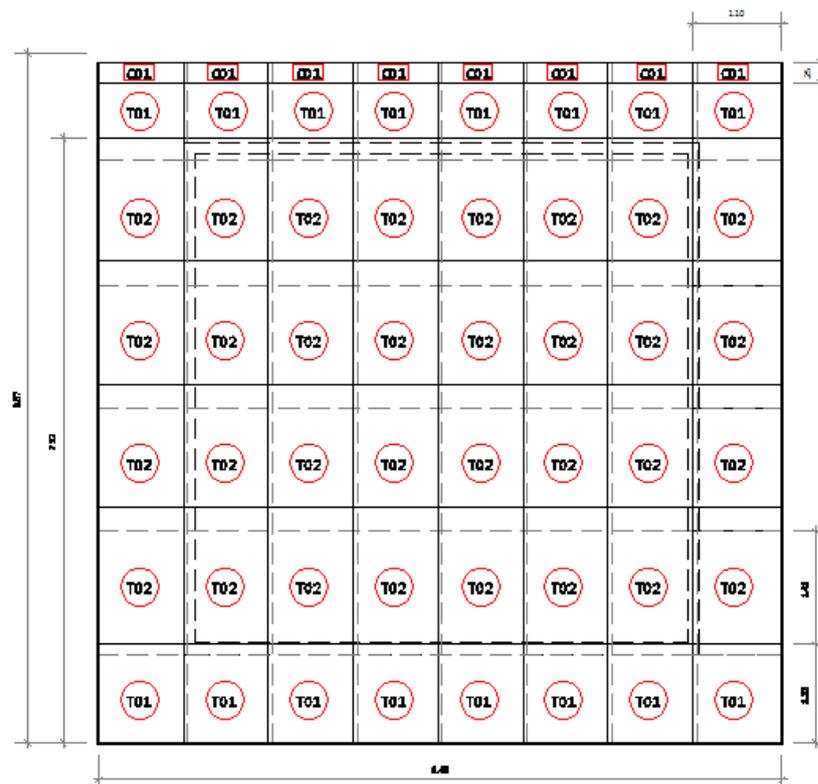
Planta baixa paginação de alvenaria, parede de 6 metros.
